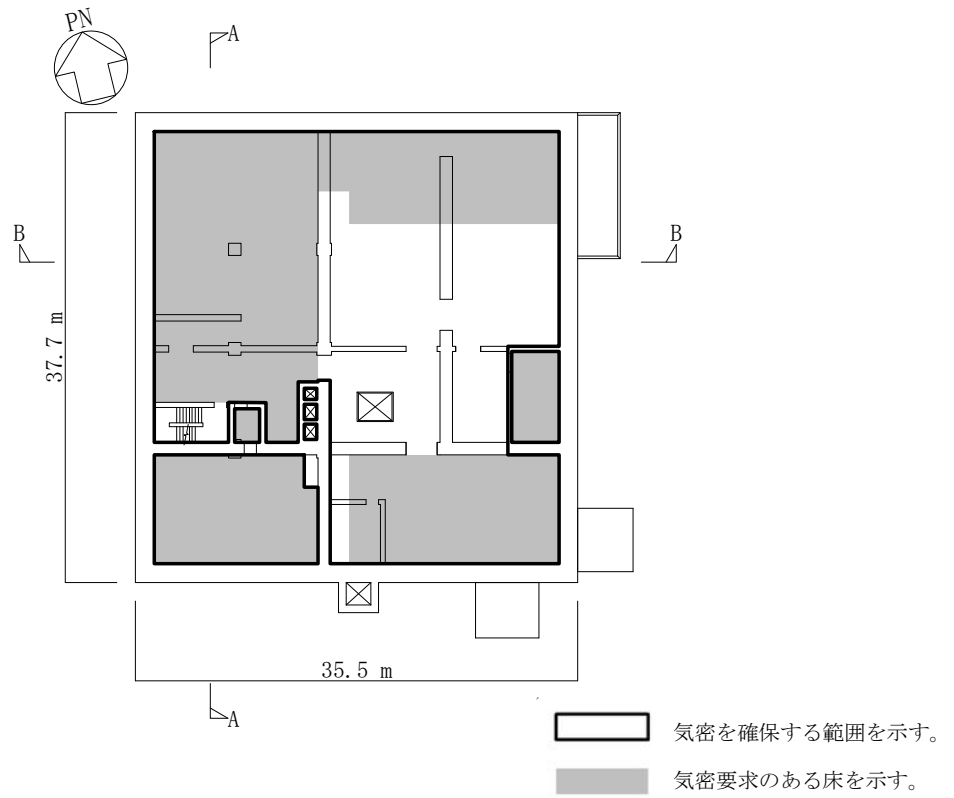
(3/7) 気密性を確保する範囲 (3 階平面図 : EL. 37.0 m)
